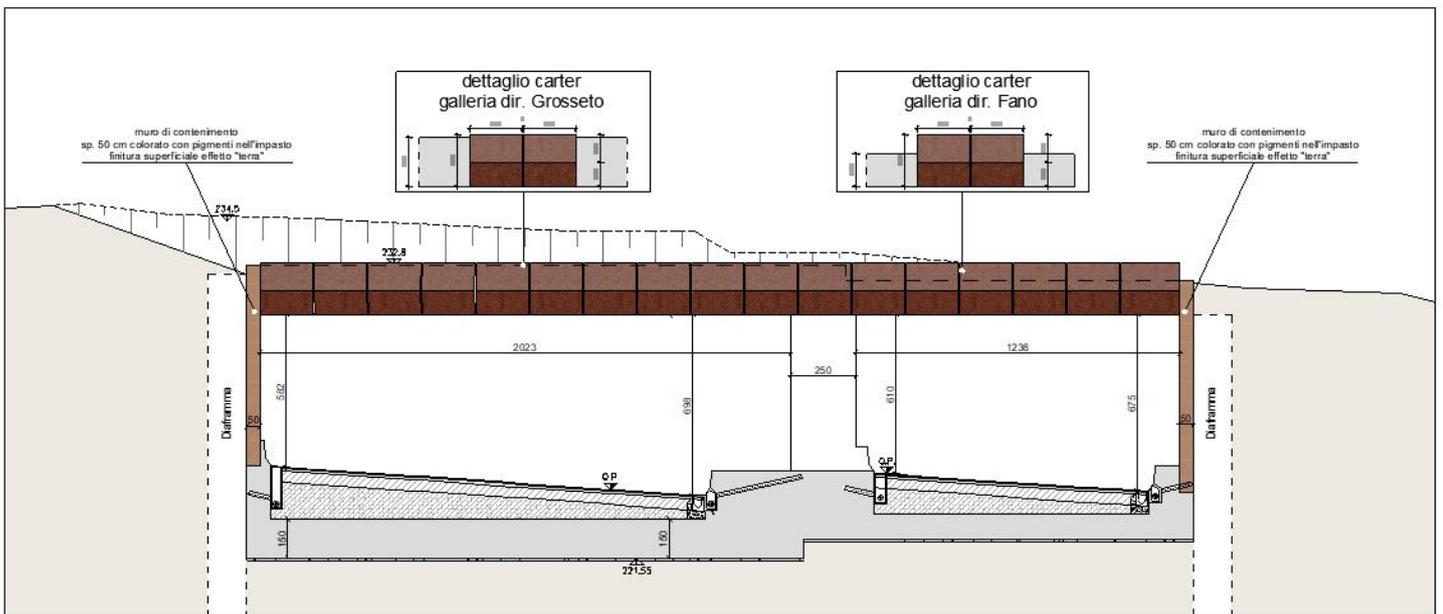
Prospetto imbocco Galleria San Lazzerò dir. Fano
